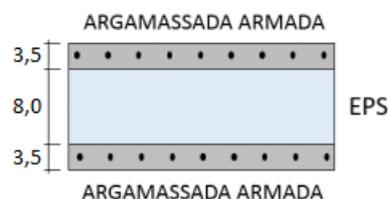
Corte esquemático do painel de EPS com revestimento de argamassa
